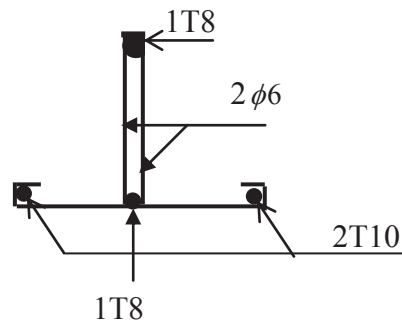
Schéma de ferrailage des poutrelles type 1 et 2 de la terrasse inaccessible
